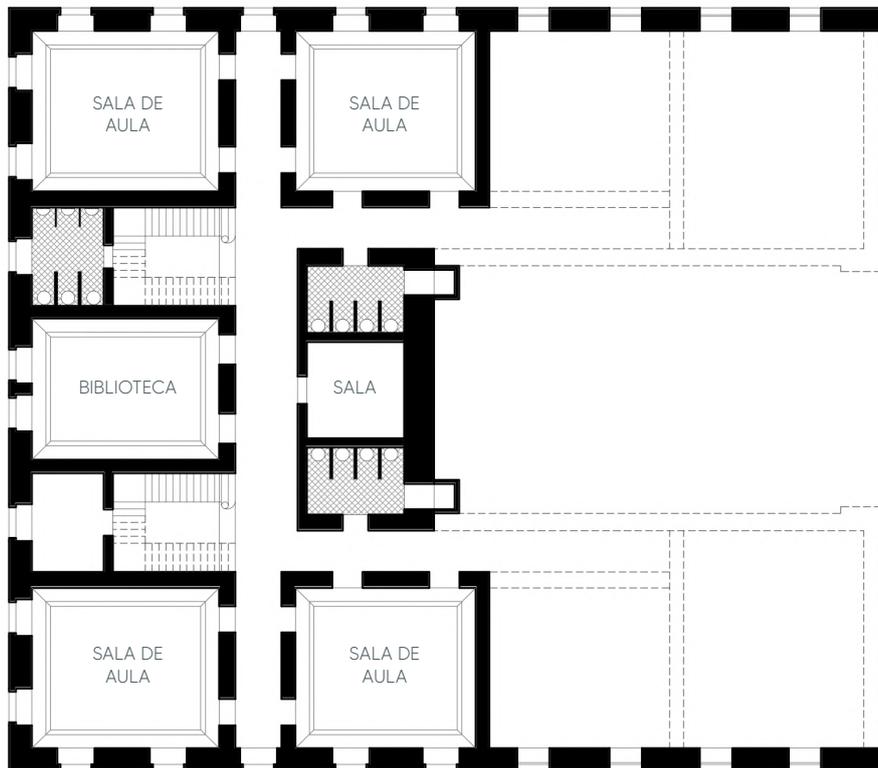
Redesenho da planta do porão semienterrado (planta da época da construção).
